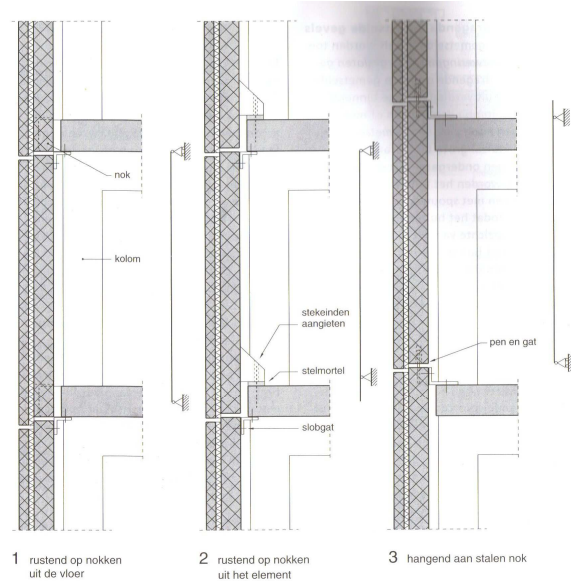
Ophangmethodes voor niet-dragende betonnen wandelementen; Ref. [30].
